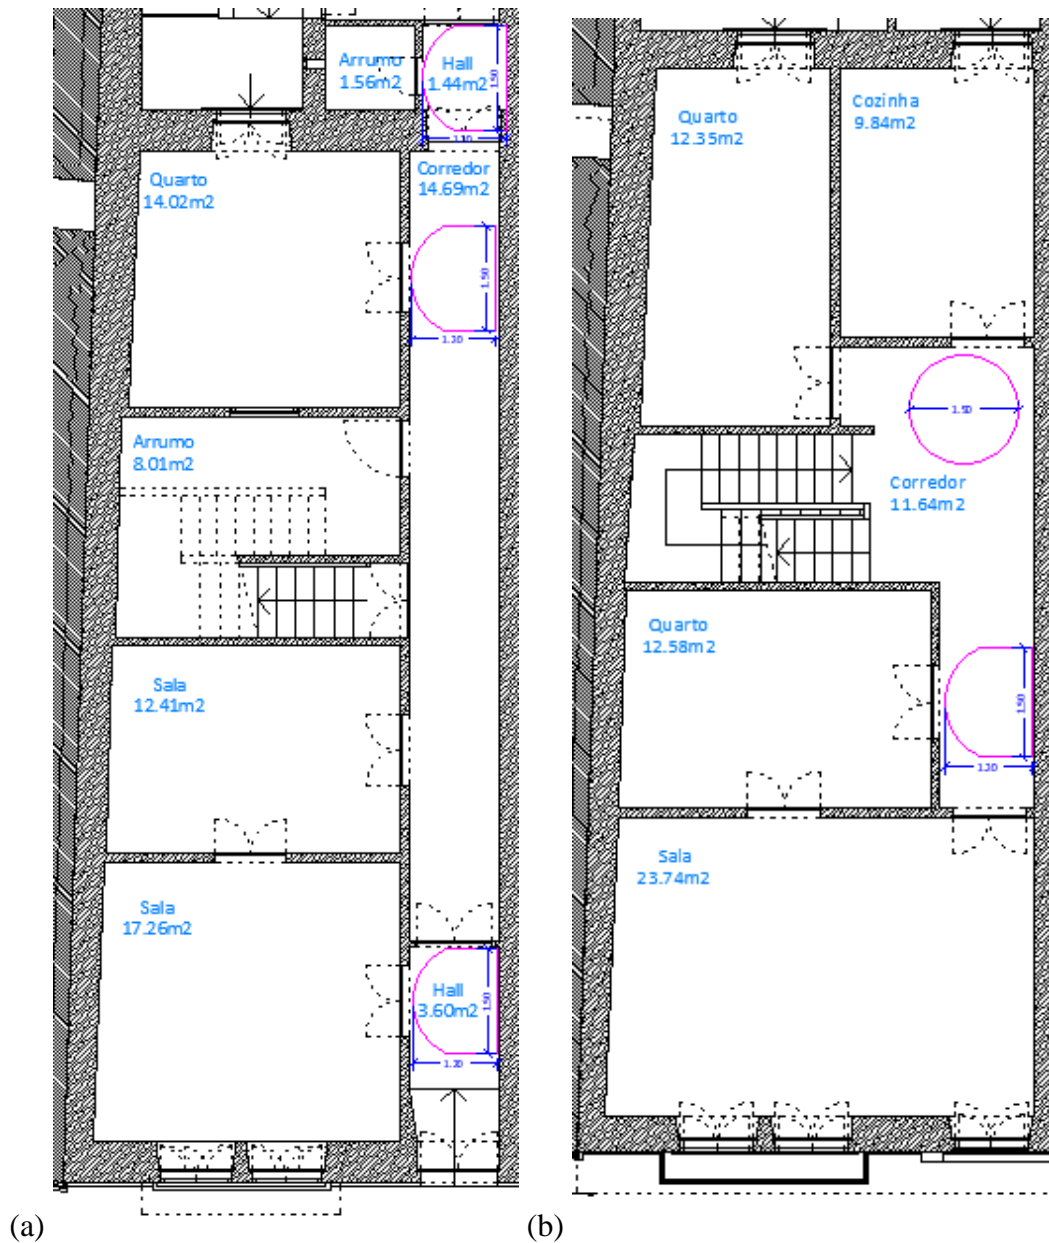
Representação em planta da zona de rotação de 180° no acesso dos fogos (SRU, 2023).
